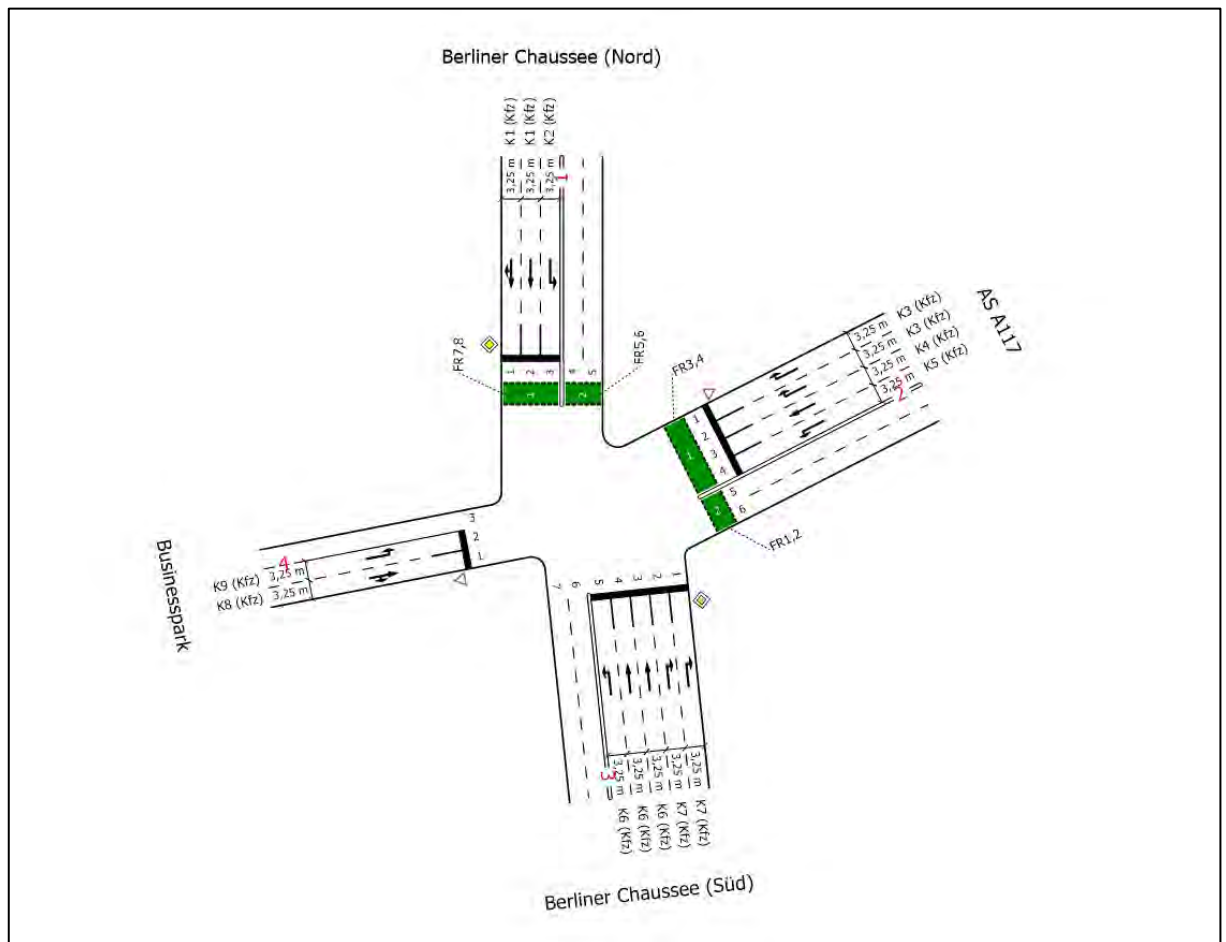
Geplanter Ausbauzustand im Prognose-Planfall des Knotenpunktes Berliner Chaussee / AS Waltersdorf - Zu- und Ausfahrt „Businesspark Waltersdorfer Dreieck“ (K1)
